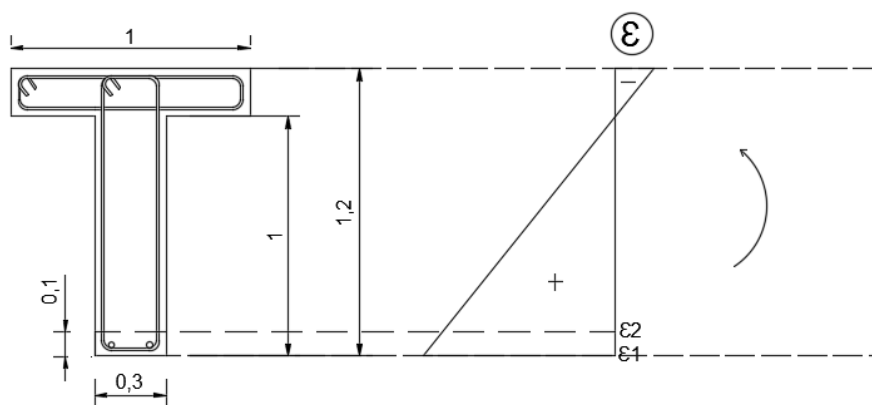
Exemplo de viga com secção em T, em betão armado, sujeita à flexão simples.
